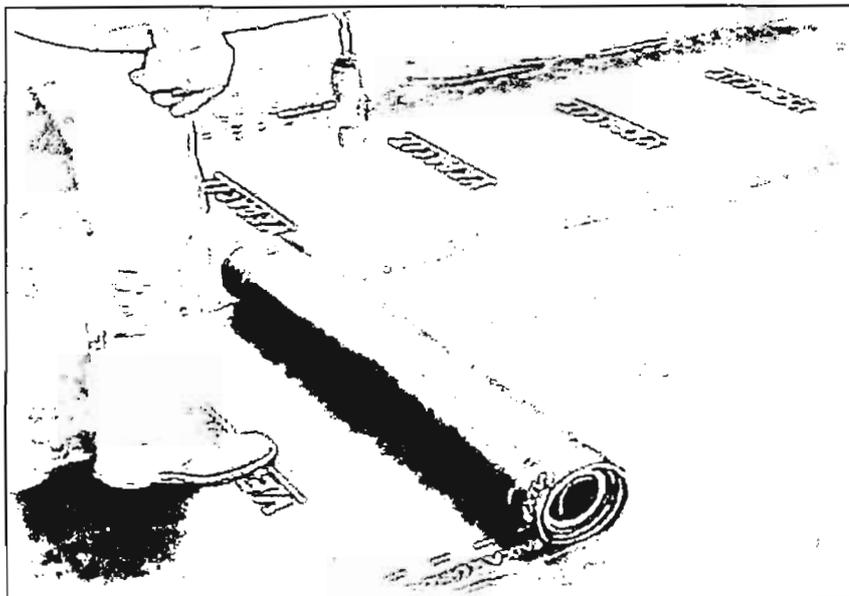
Imagem do sistema de aplicação de impermeabilização em manta asfáltica.
